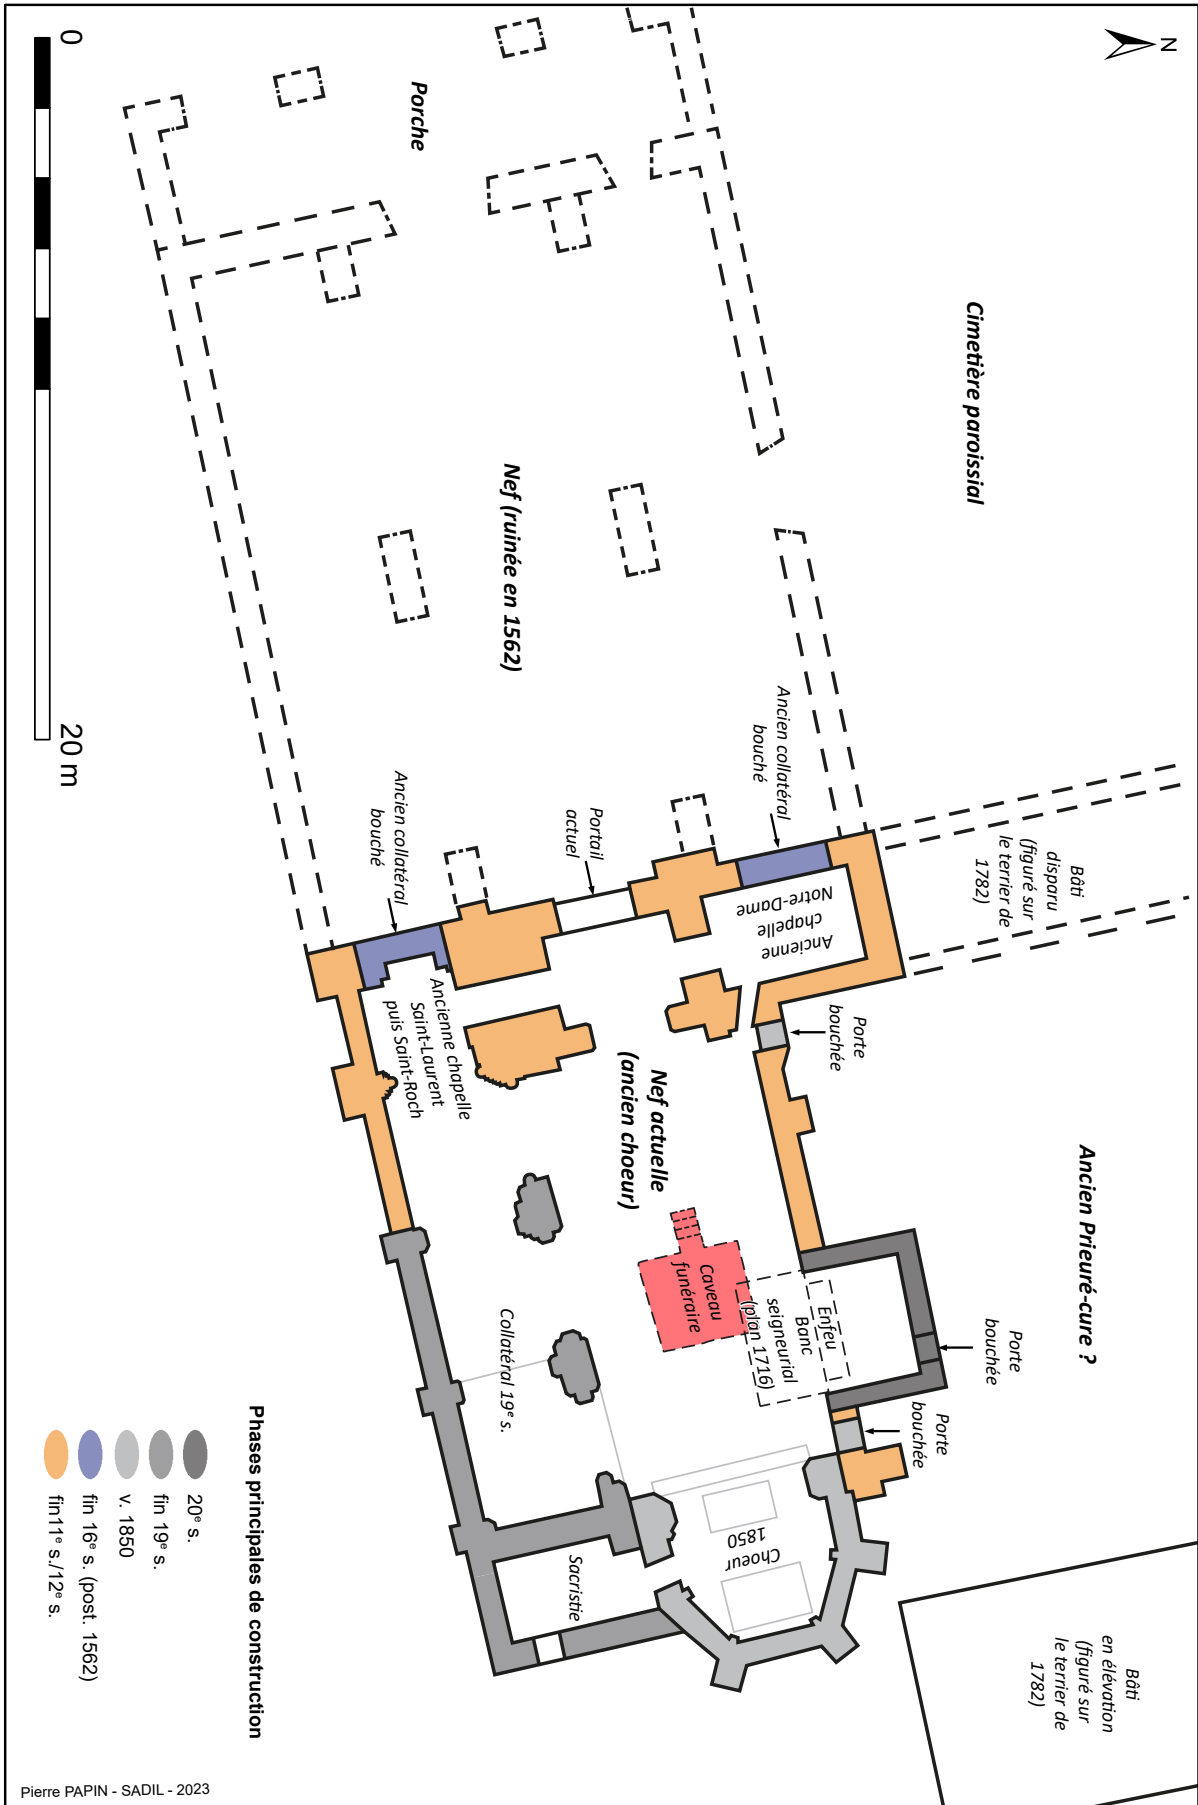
Plan de l'église Saint-Pierre de Seuilly
